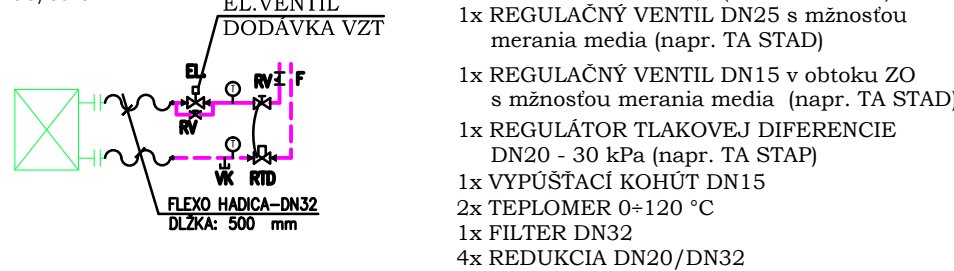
DETAIL PRIPOJENIA VZT PODSTROPNÝCH JEDNOTEK
